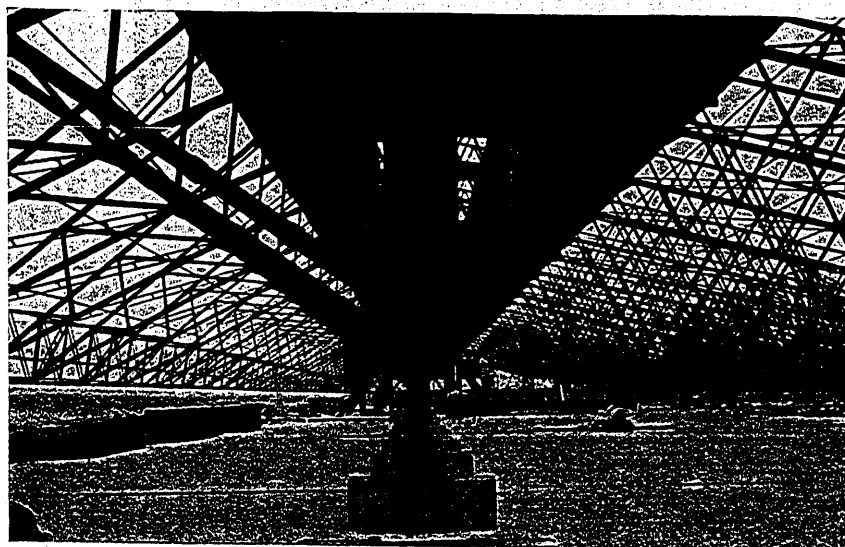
Hangar de Torrejón. Elevación de la cubierta.
